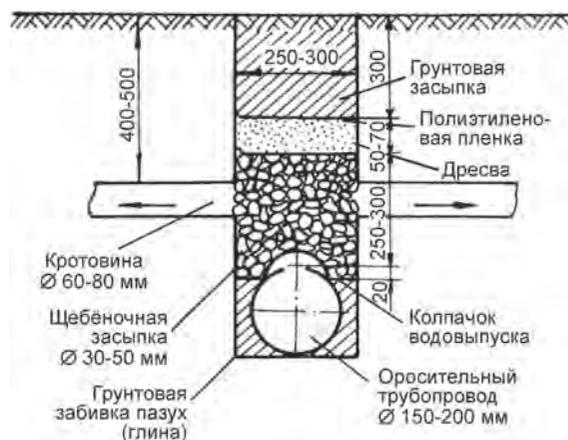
Поперечный разрез траншеи оросительного трубопровода с пористой засыпкой
